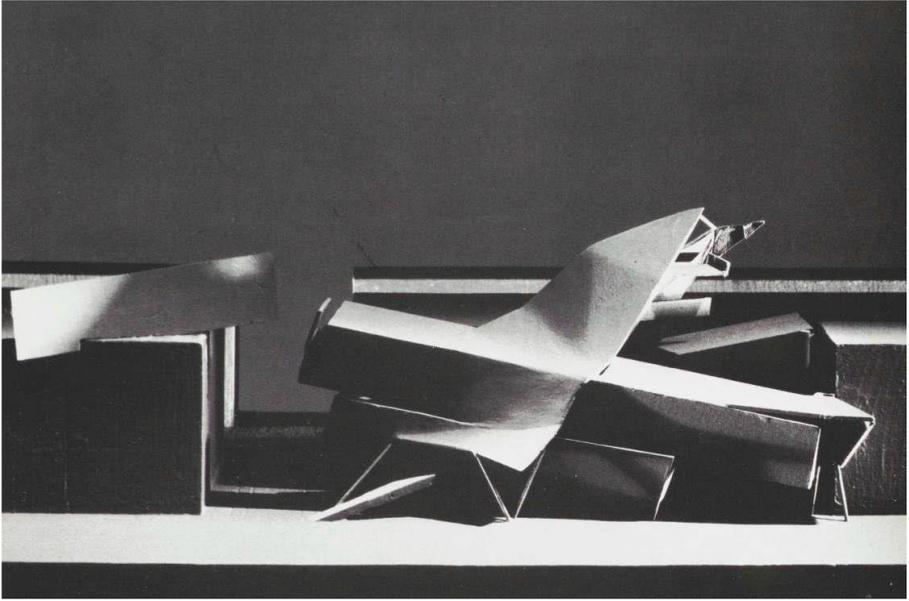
Potongan Memendek, *The Rooftop Remodeling
